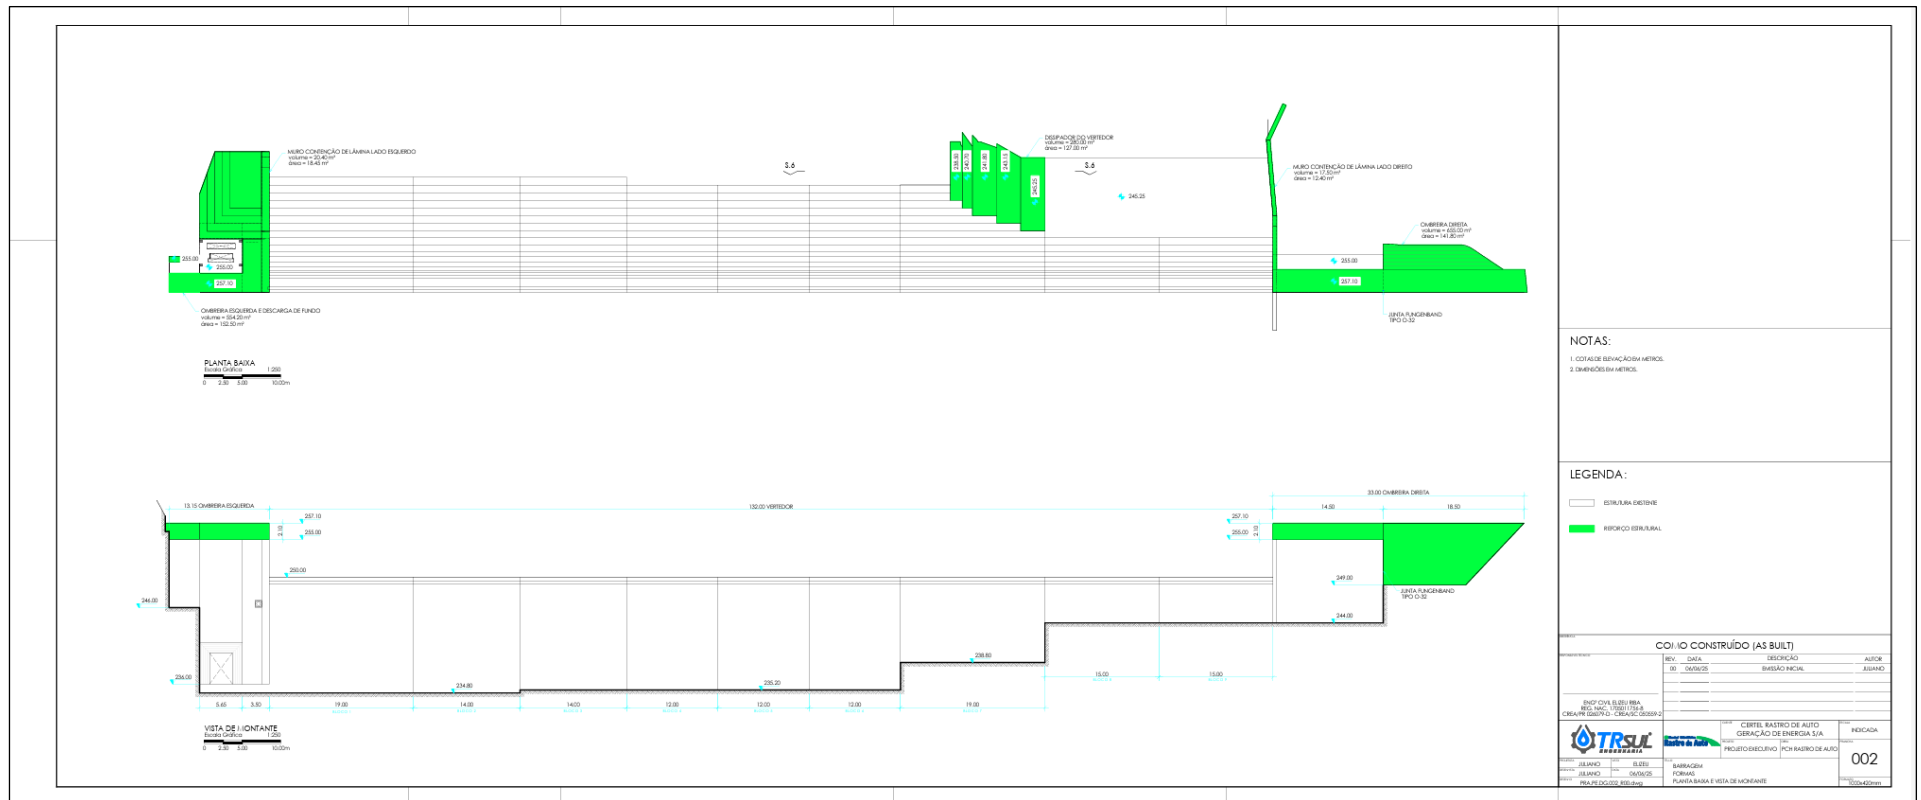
Barramento PCH RDA - Planta e Vista Montante
